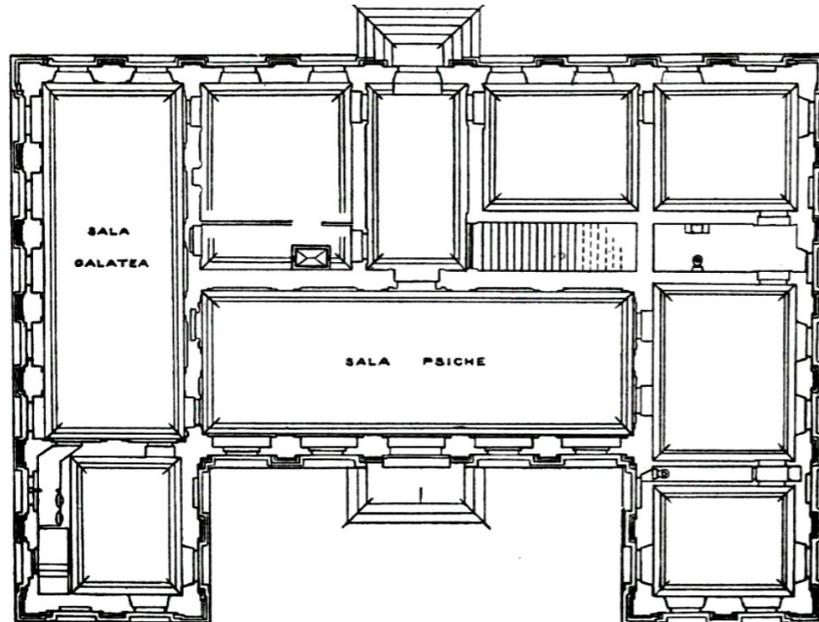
Anonym: Grundriss des EG der Villa Farnesina in Rom, 1929, o.A.
